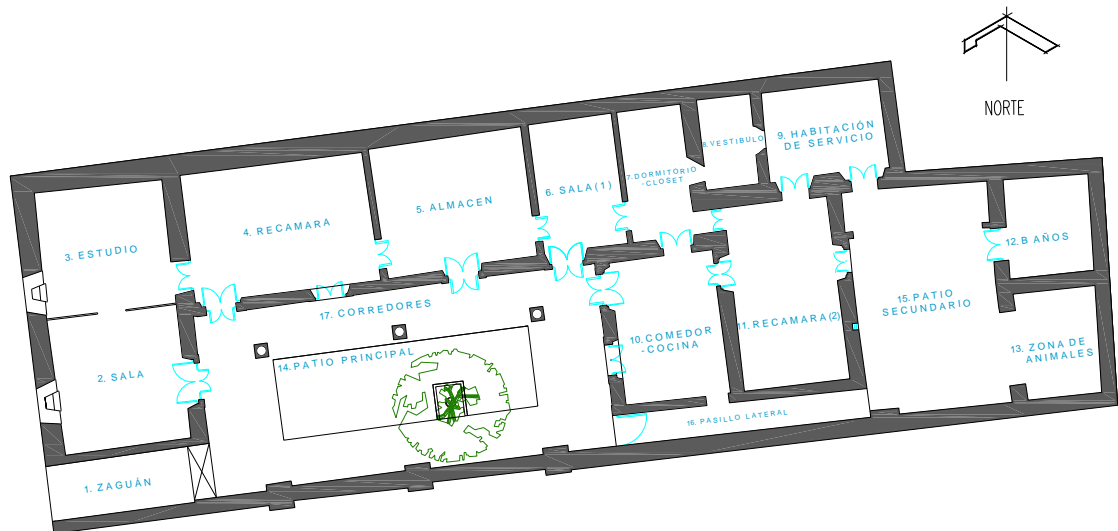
Plano de la disposición actual de los espacios del inmueble.
